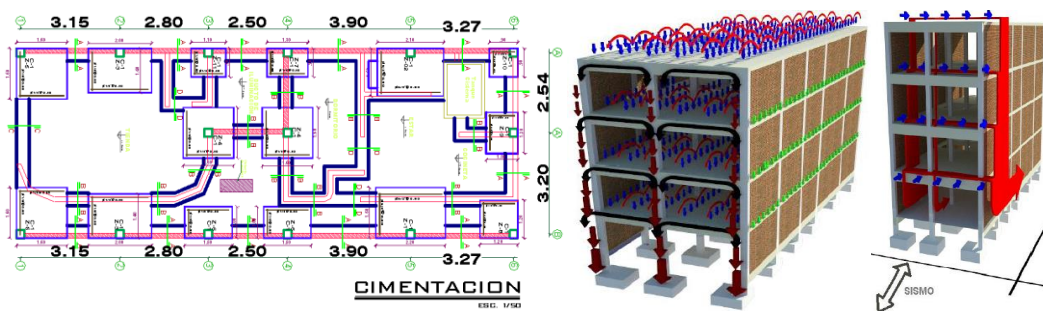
Plano común encontrado en el distrito de Huancayo donde además de cimiento corrido se adiciona innecesariamente zapatas aislada
